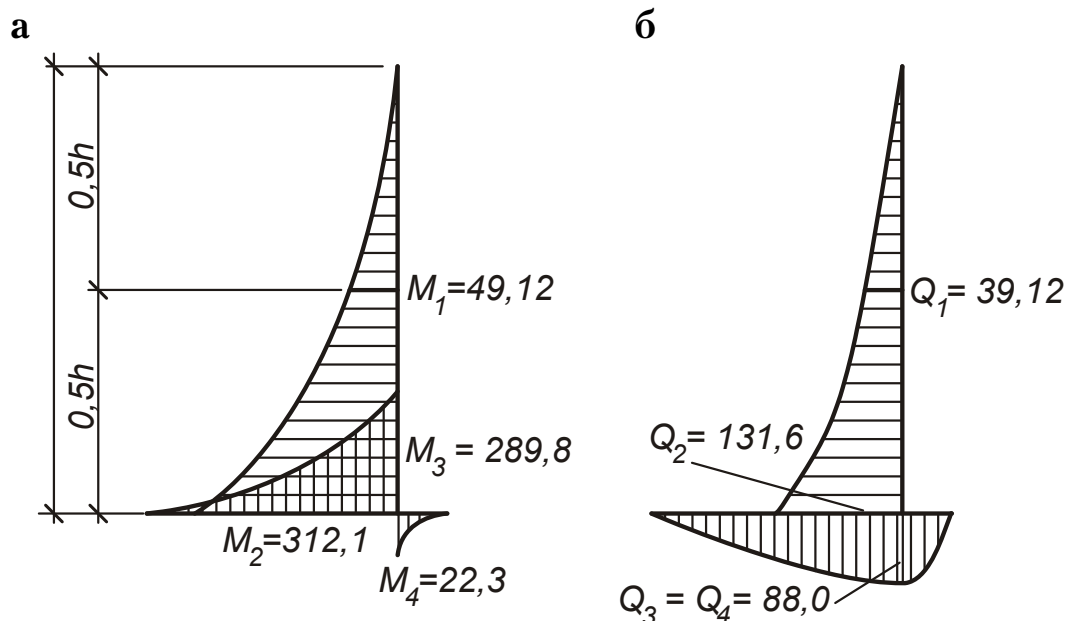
Эпюры внутренних усилий в элементах угловой подпорной стены:
